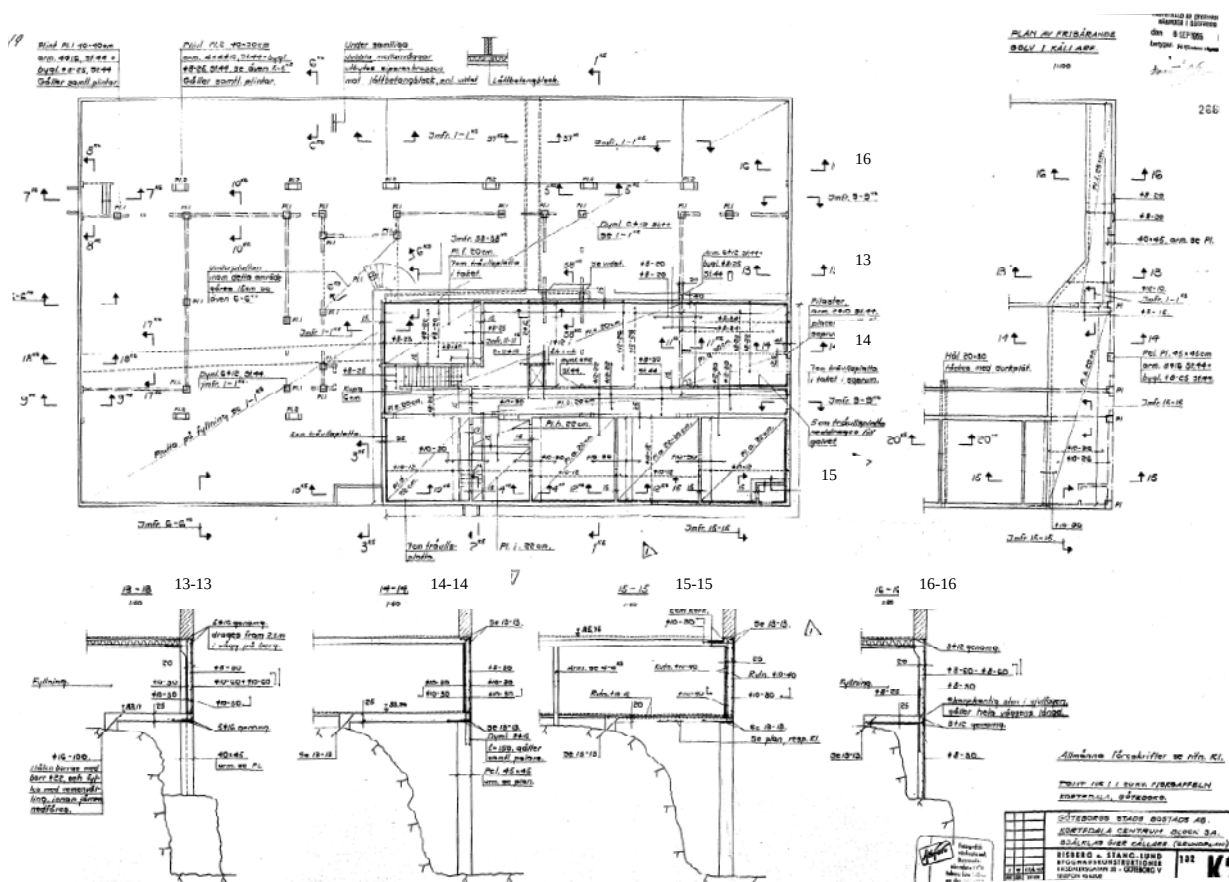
Plan över Kortedala Torg 4 med elevationsöversikt.
